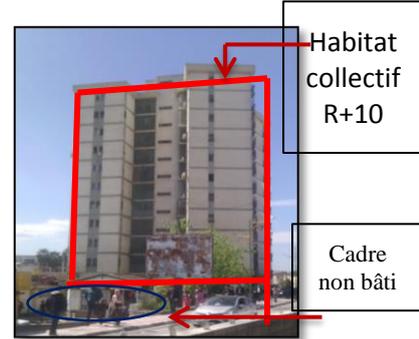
Façade au niveau de boulevard ABÈNE REMDHAN
